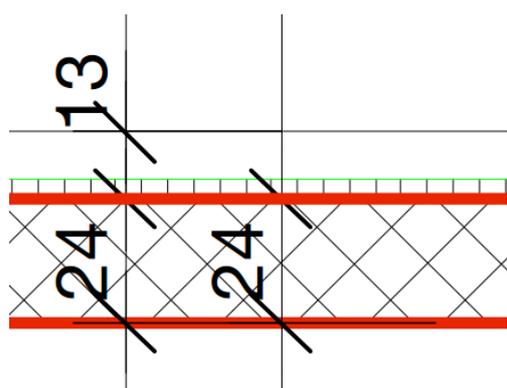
Bodenaufbau BGH-Gebäudeteil
